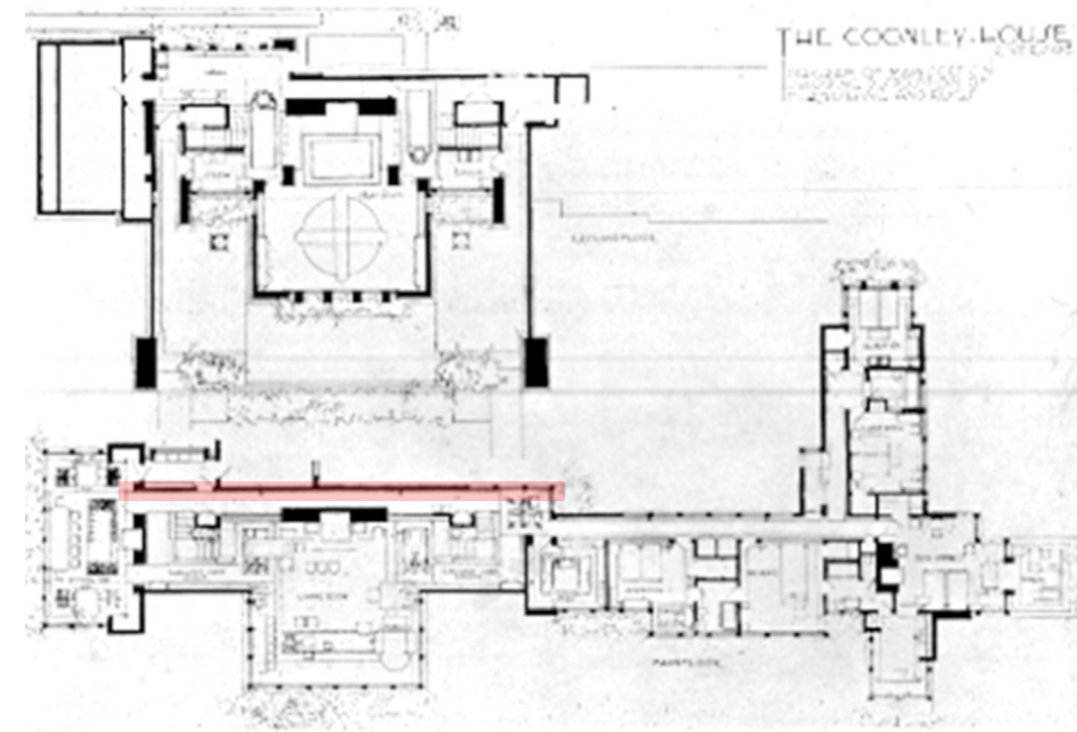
Planta casa Coonley en la que se destaca muro seccionado.
